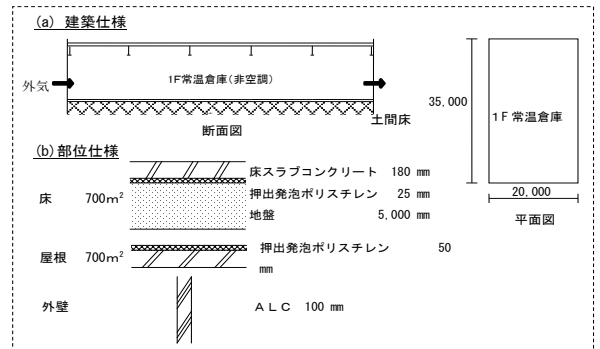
建物モデル (土間床倉庫) (Building Model (Dirt Floor Warehouse))
